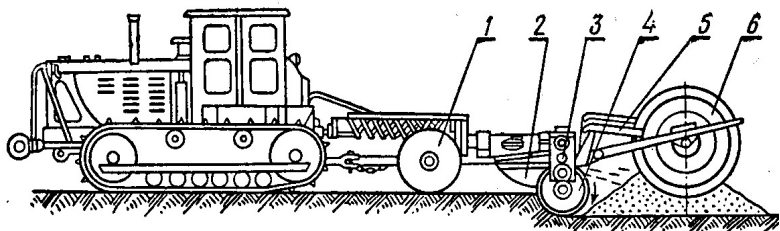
Схема работы фрезерной машины МТП-42А: 1,6 – передние и задний опорные катки; 2 – отбойная плита; 3,7 – бортовых и конический редукторы; 4 – фреза; 5 – гидравлическая система; 8 – рама; 9 – буфер.
